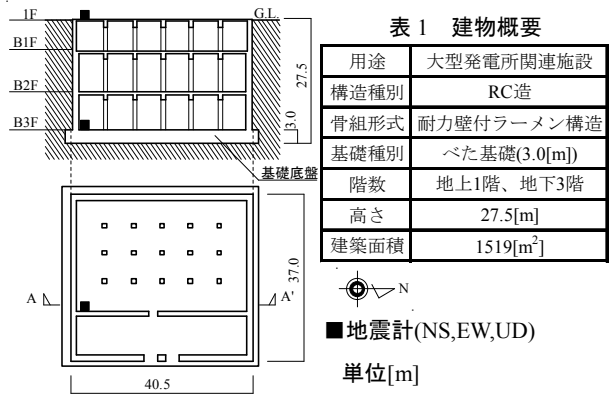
対象建物 A-A'断面図(上)、地下3階平面図(下)
